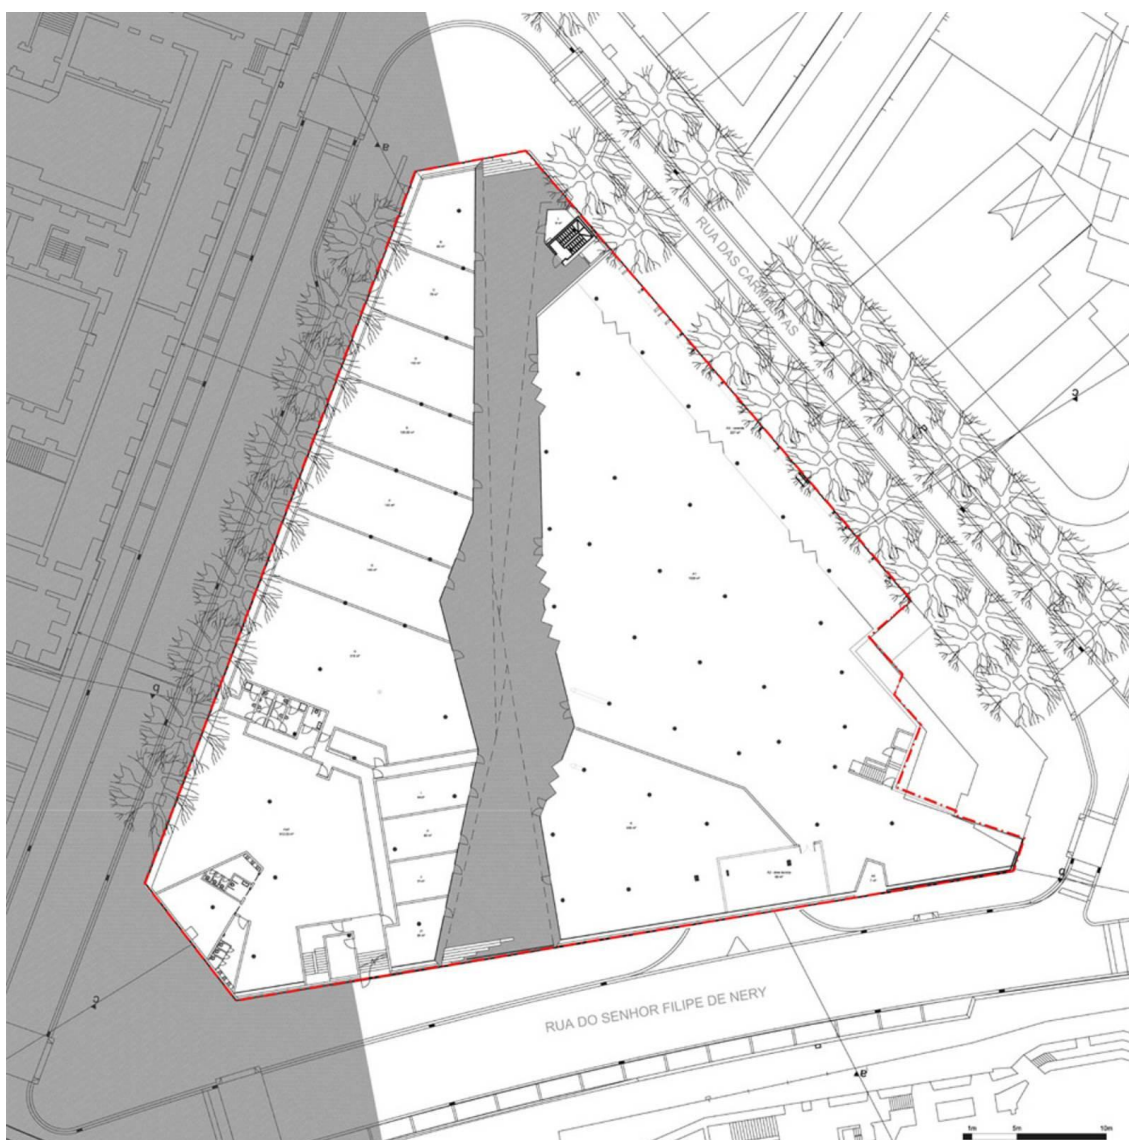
Planta do piso térreo da Praça de Lisboa, Porto.
